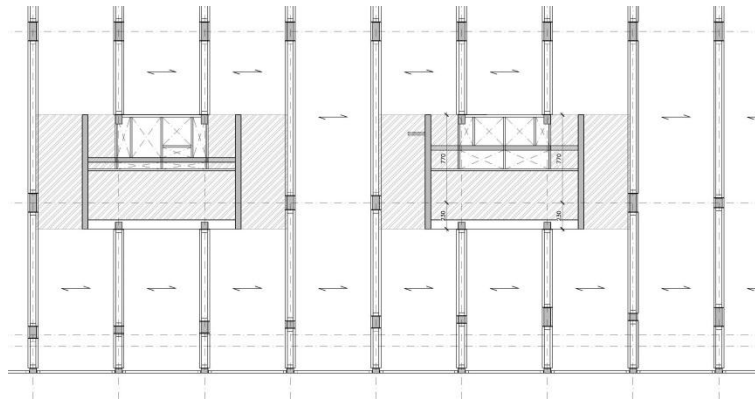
Pianta di una disposizione tipica di telai, lastre alveolari e pareti di irrigidimento
